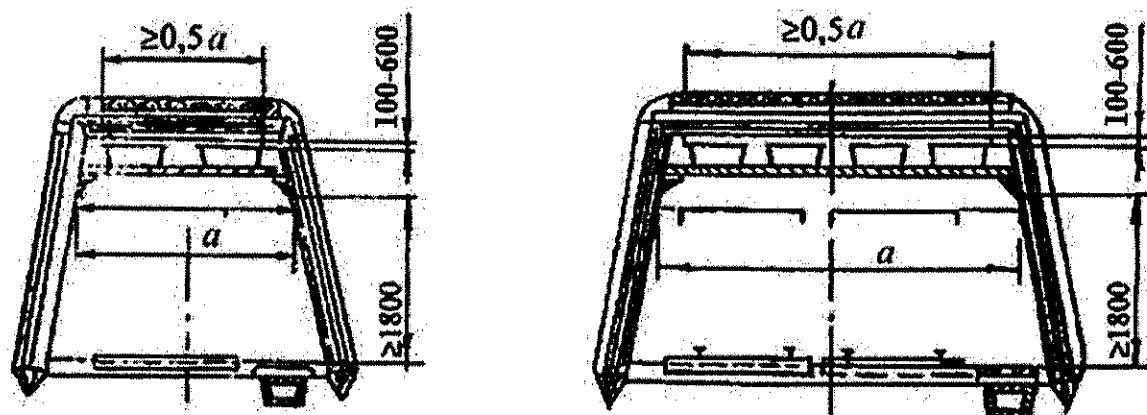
Схема установки водяных заслонов в выработках, закрепленных деревянной крепью
